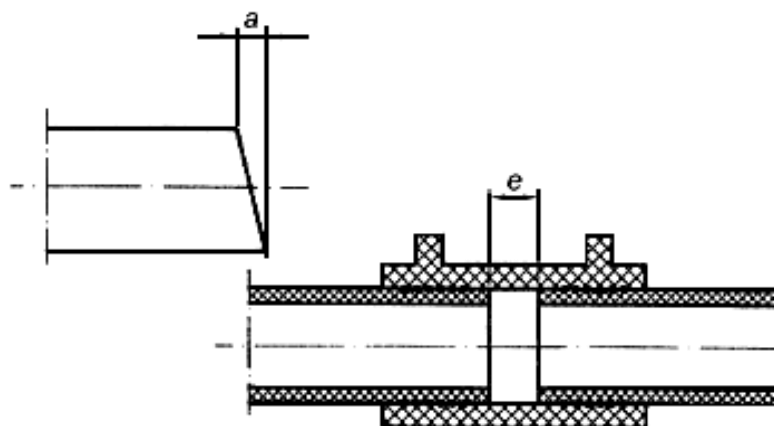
Схема подготовки торцов труб к сварке:
